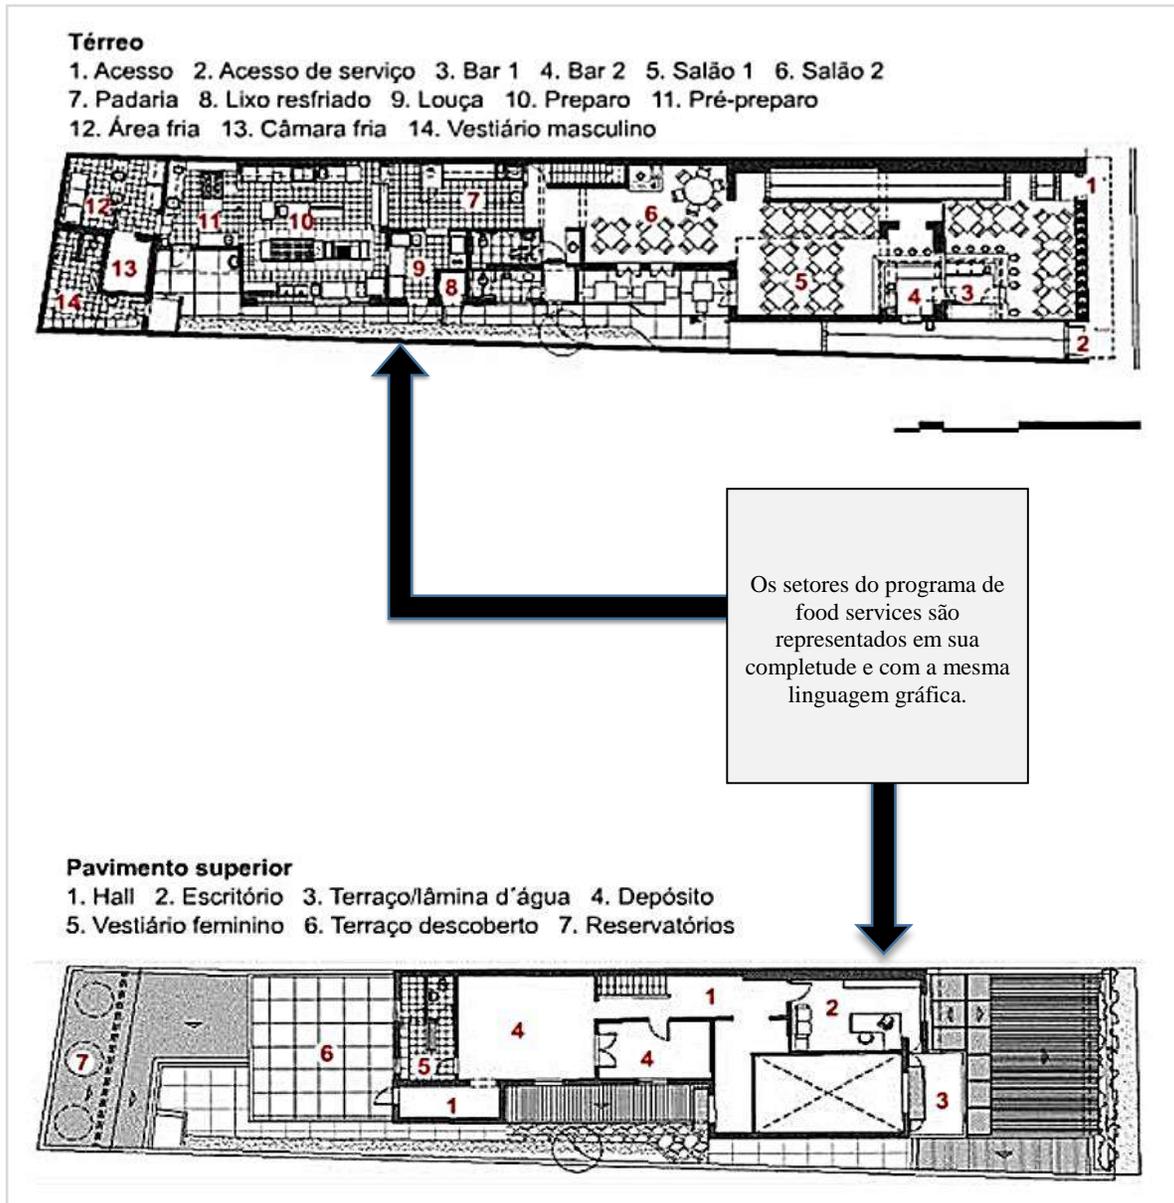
Plantas baixas publicadas em Projeto Design nº313.
